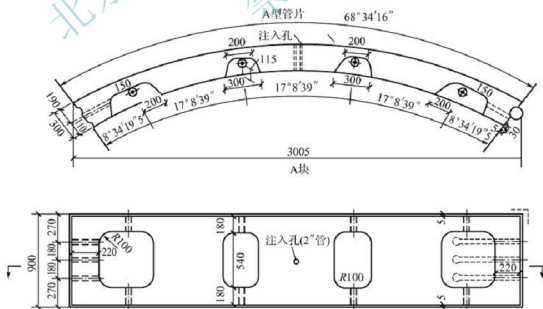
钢筋混凝土箱形管片 (A 型管片; 单位: mm)
